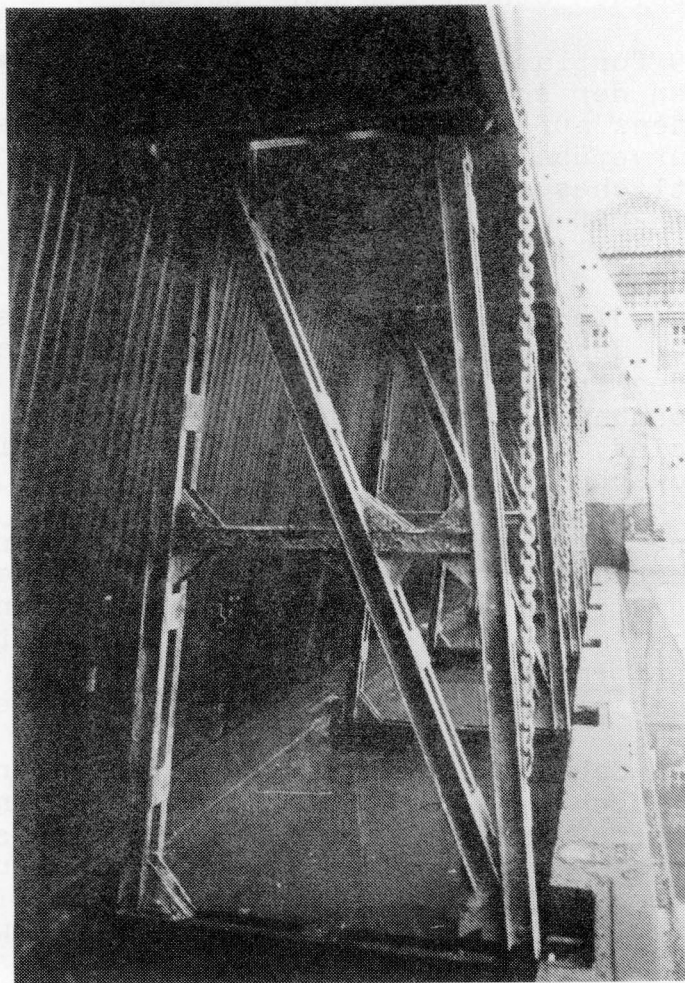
Nadelwehr-Notverschluß, bestehend aus Lagerböcken (Stahlfachwerk St 37); darauf Stahlrahmen mit Tränenblechabdeckungen; davor Stahlrohrnadeln zur Abdichtung
